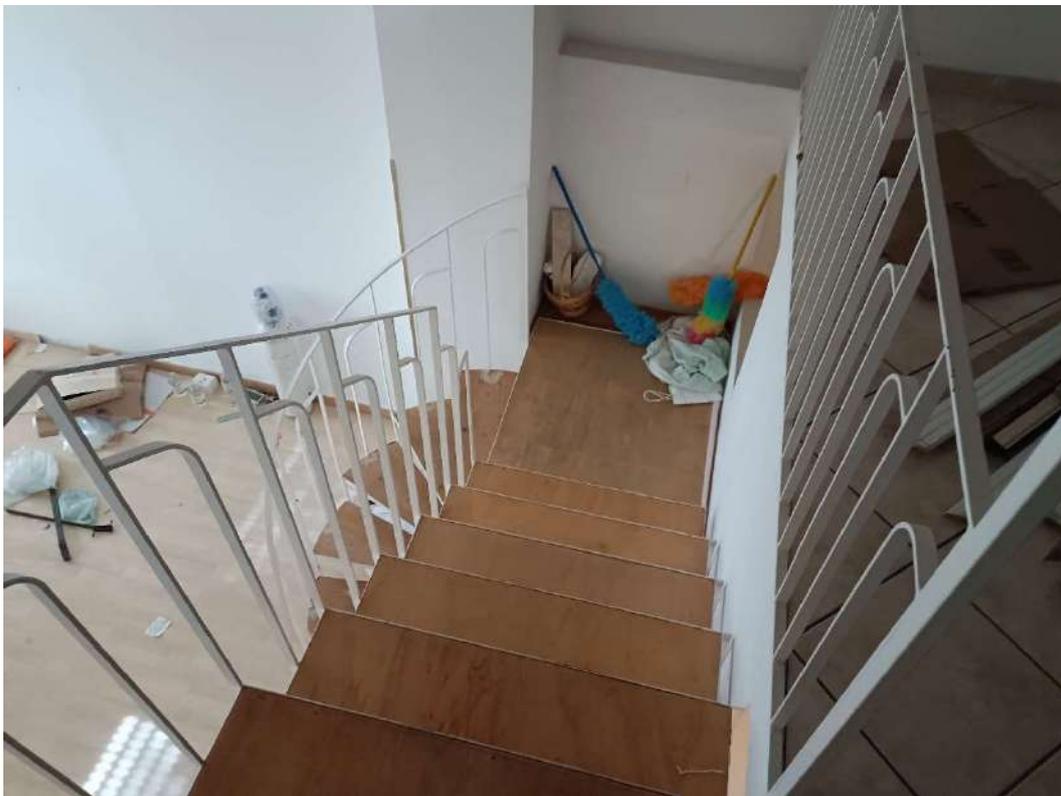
scala di accesso al piano ammezzato Sub 100
